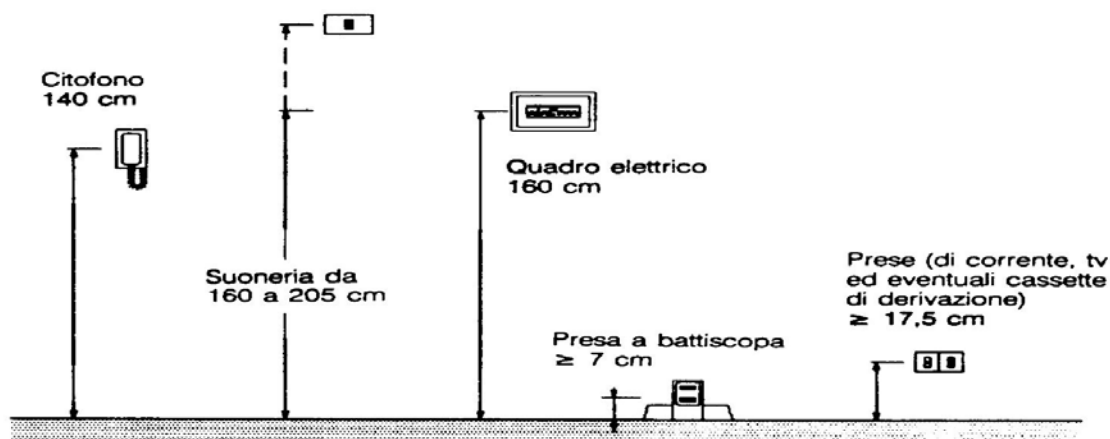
Quote di installazione delle apparecchiature, secondo la norma CEI 64-8 e la guida CEI 64-50
